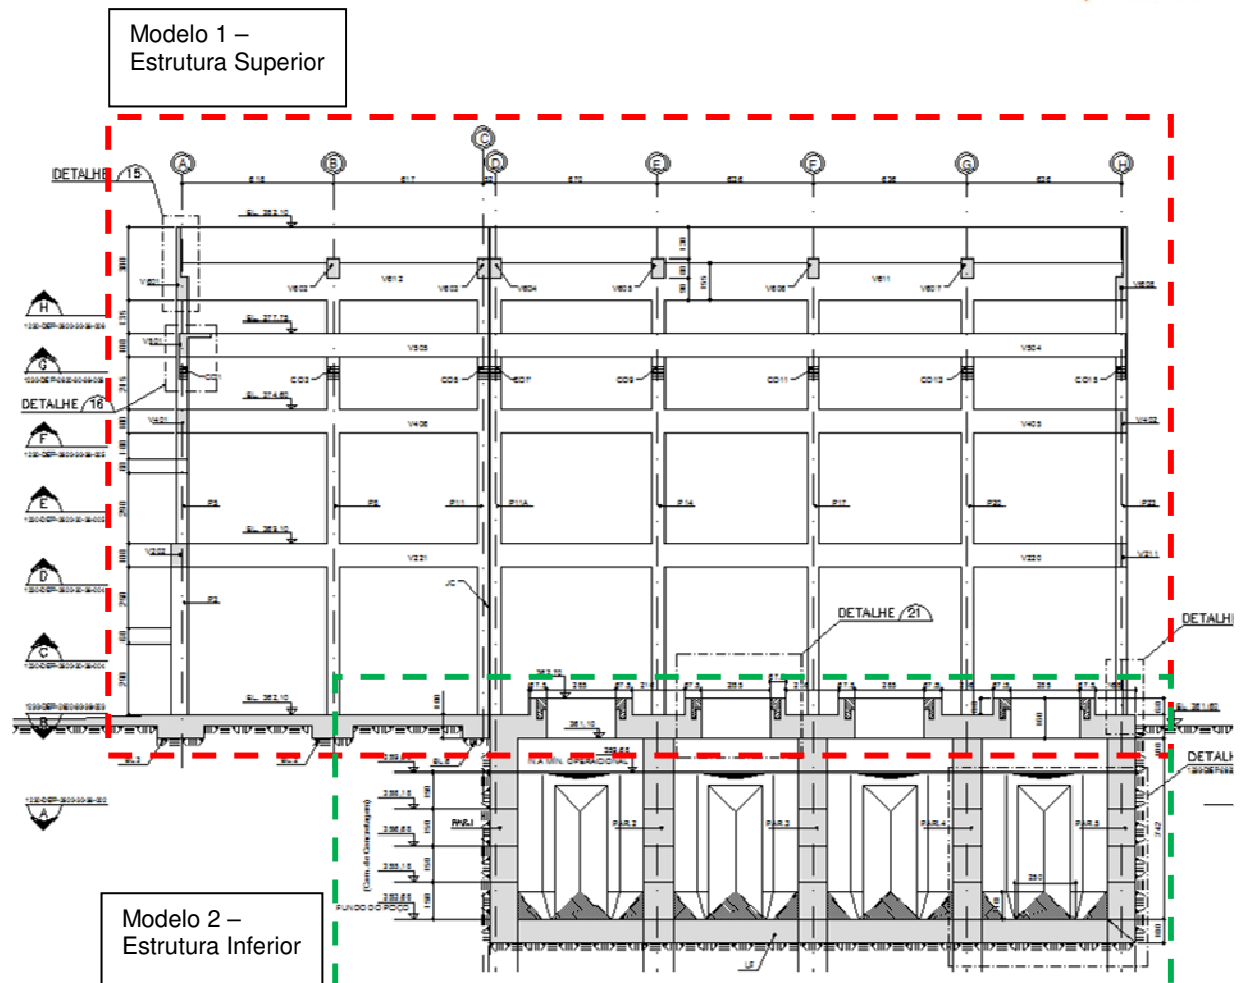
Estação de Bombeamento – Corte Longitudinal
